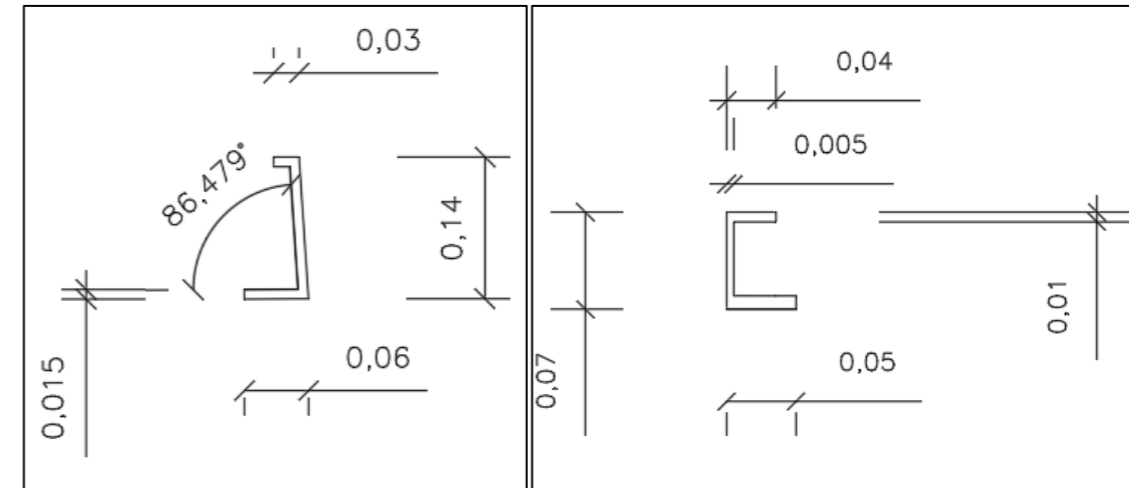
Dimensiones de los perfiles en “C” que encofran la losa del tablero. Fuente: Elaboración Propia (AutoCAD)
